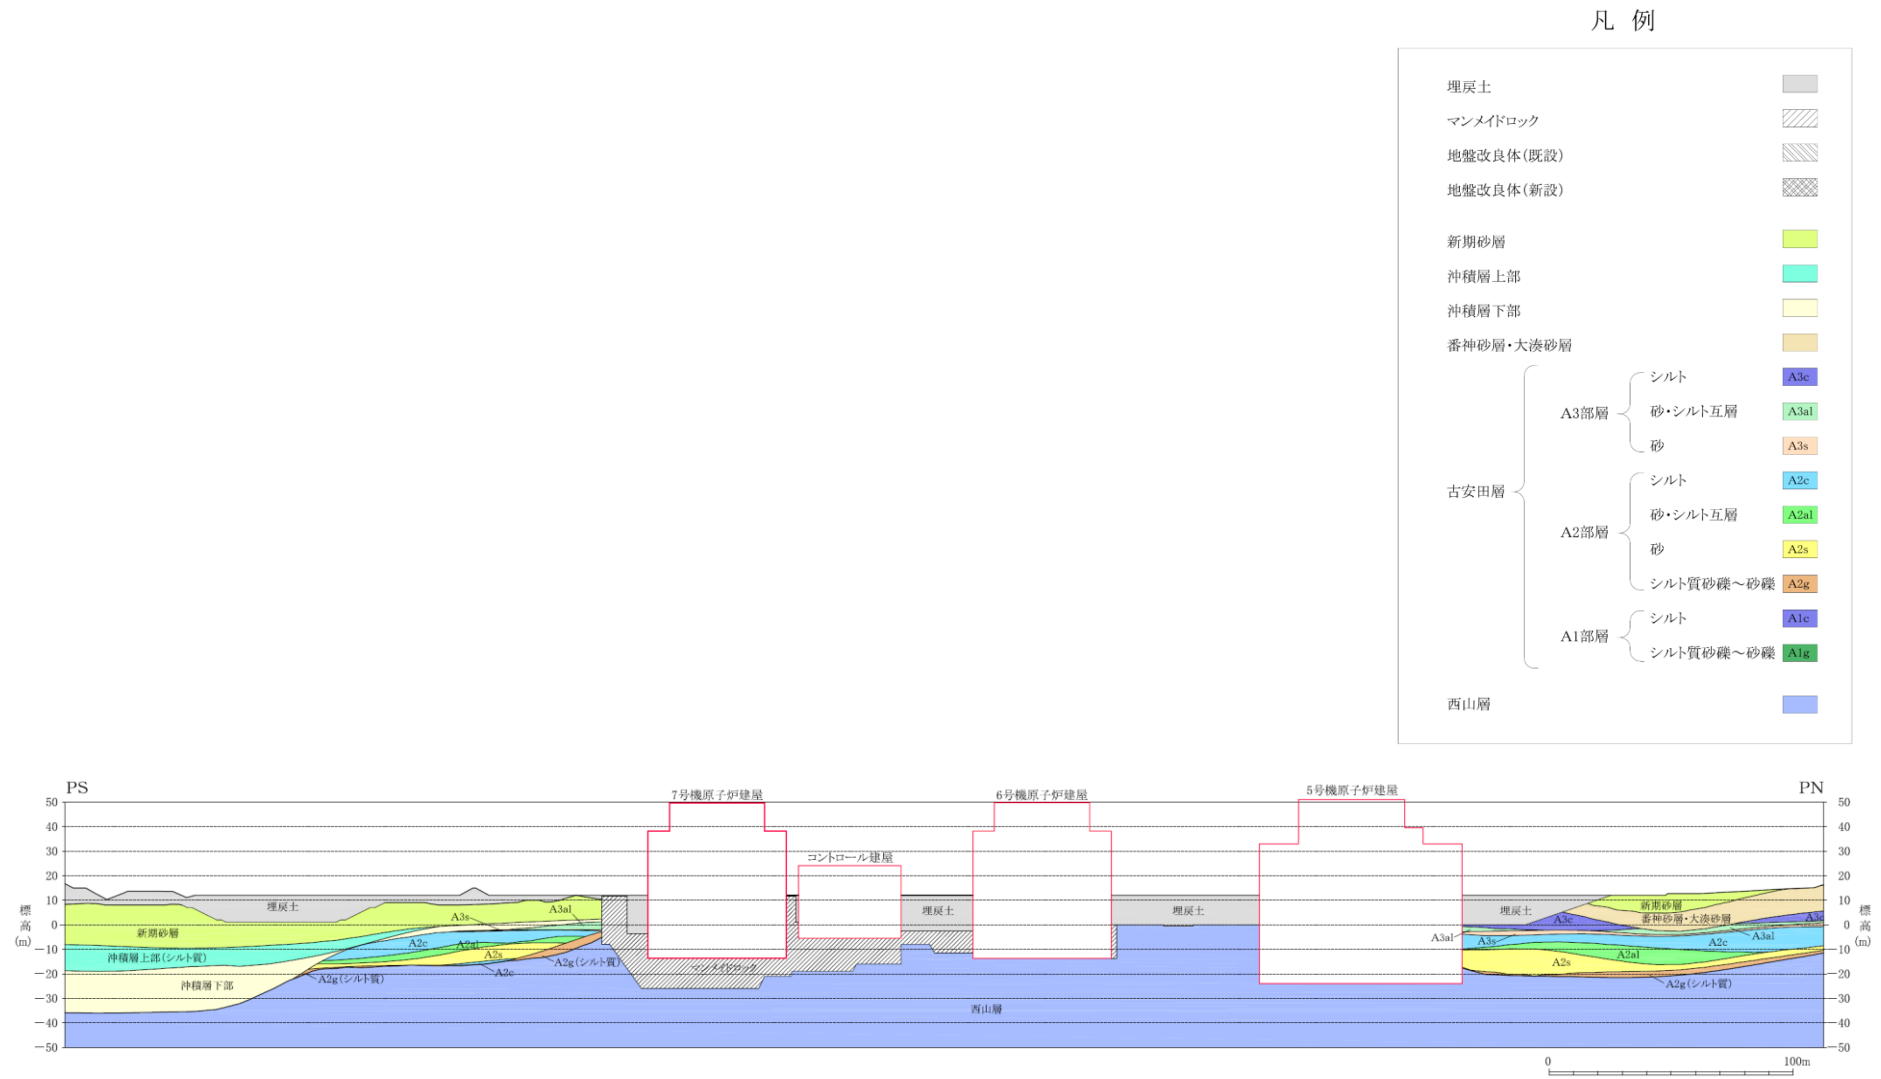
汀線平行 地質断面図 (原子炉建屋炉心中央) (A-A断面)
